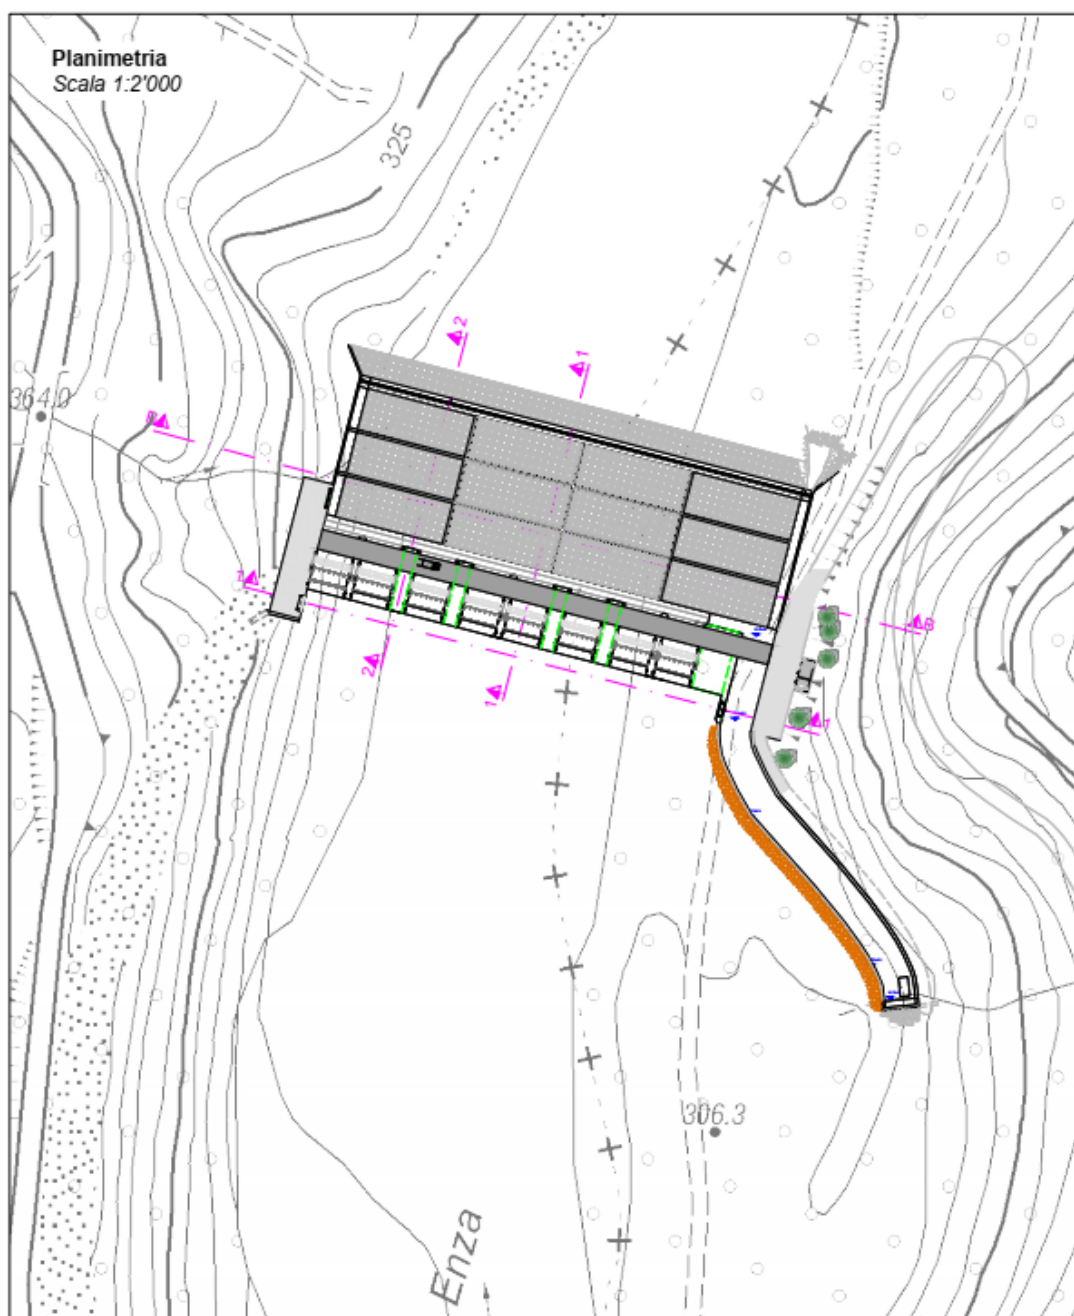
estratto della planimetria di progetto invaso 7 - VETTO
